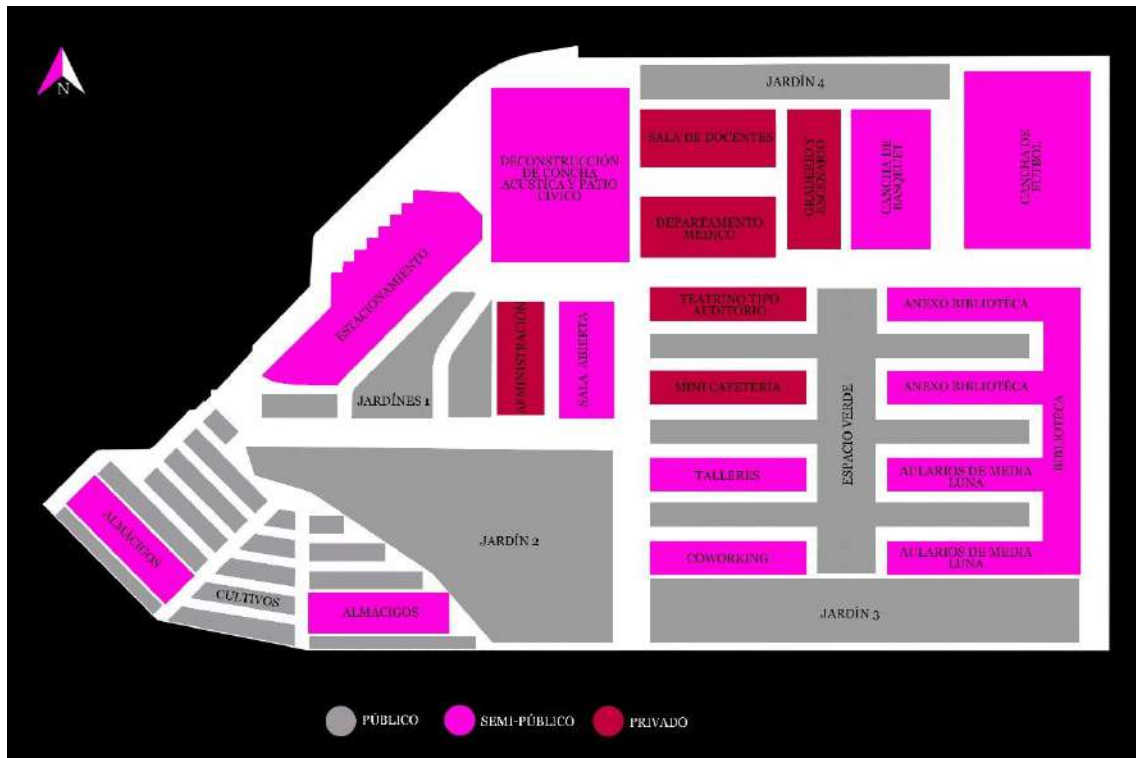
Zonificación por accesibilidad en planta baja, en la propuesta de rediseño de la UEM'S.
